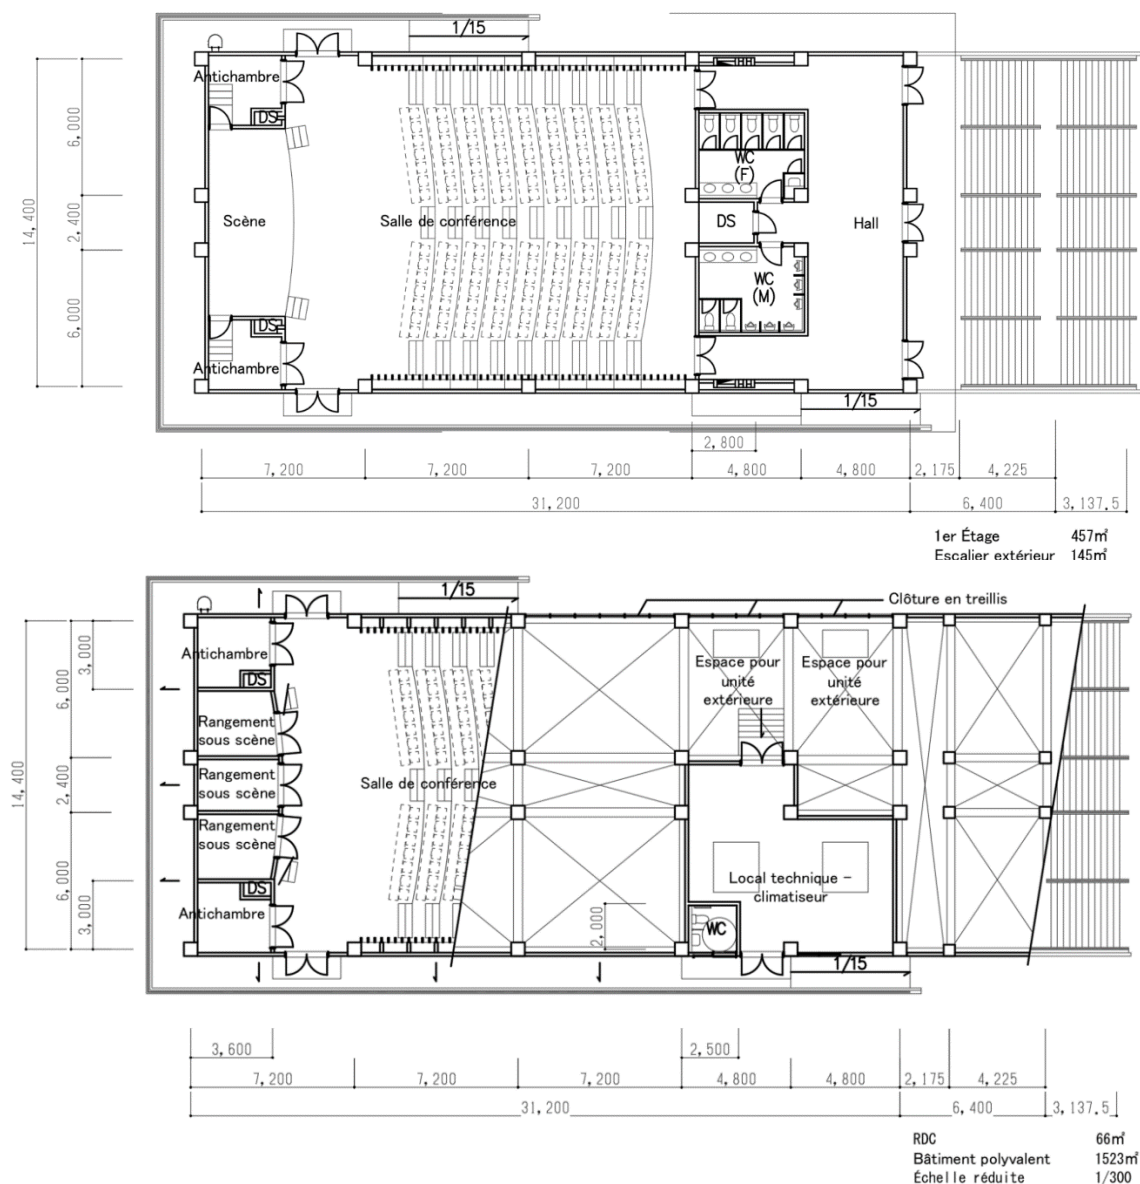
Plan d'étage du bâtiment polyvalent
